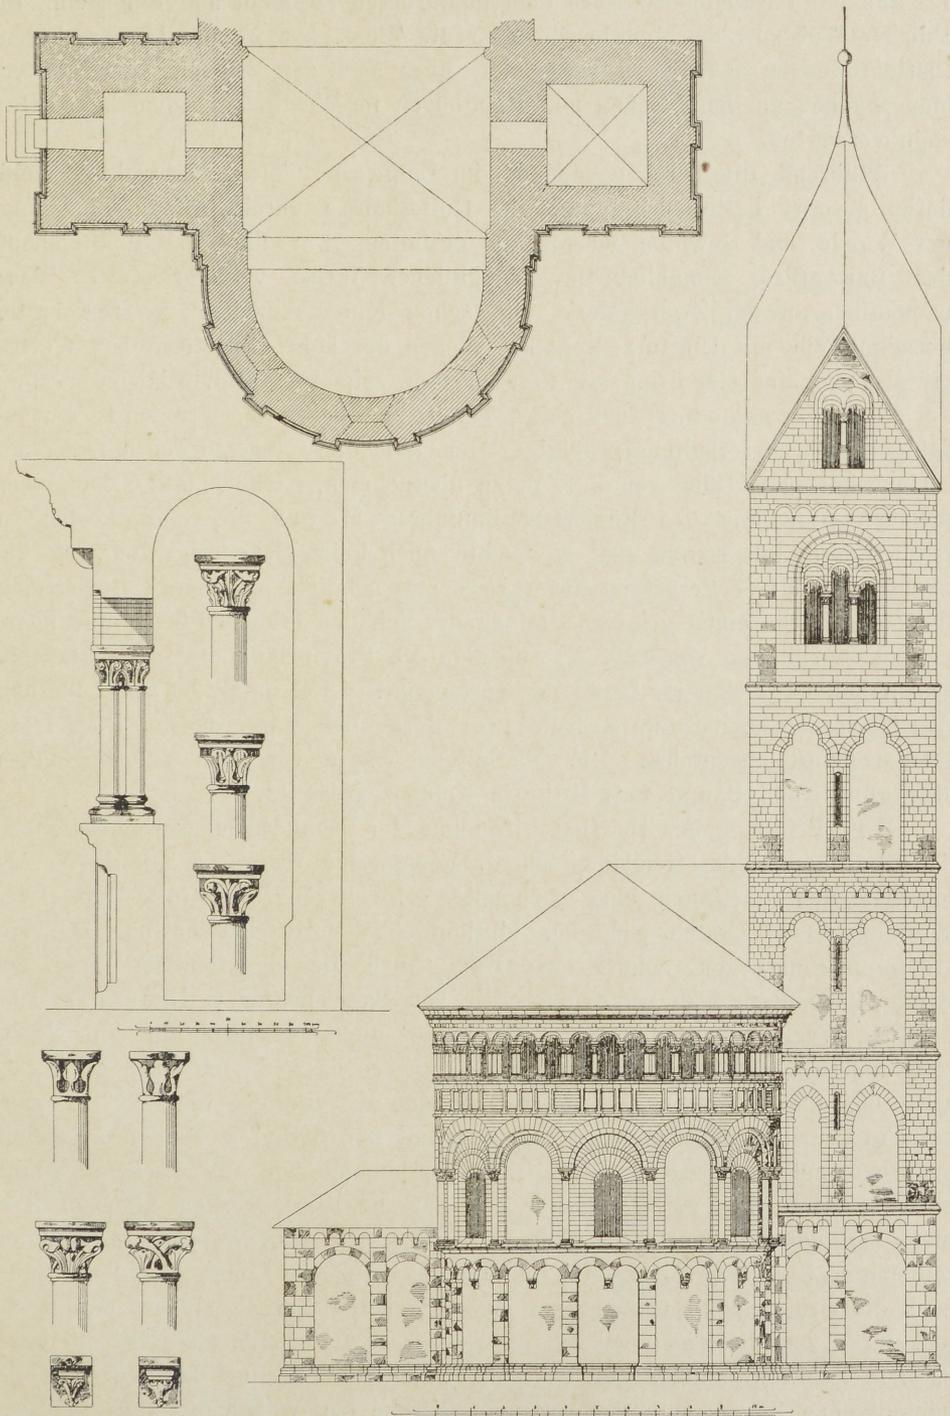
Lonngig, kathol. Pfarrkirche. Grundriss, Aufriss des Chores und Details der Zwerggalerie.
